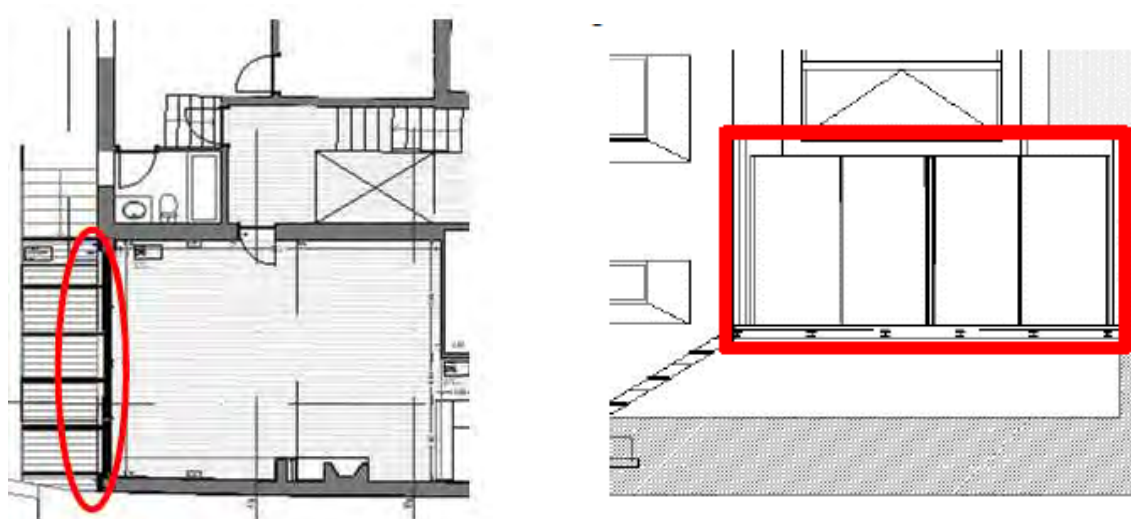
Identificação em planta e alçado da parede exterior da sala, Pe1.
